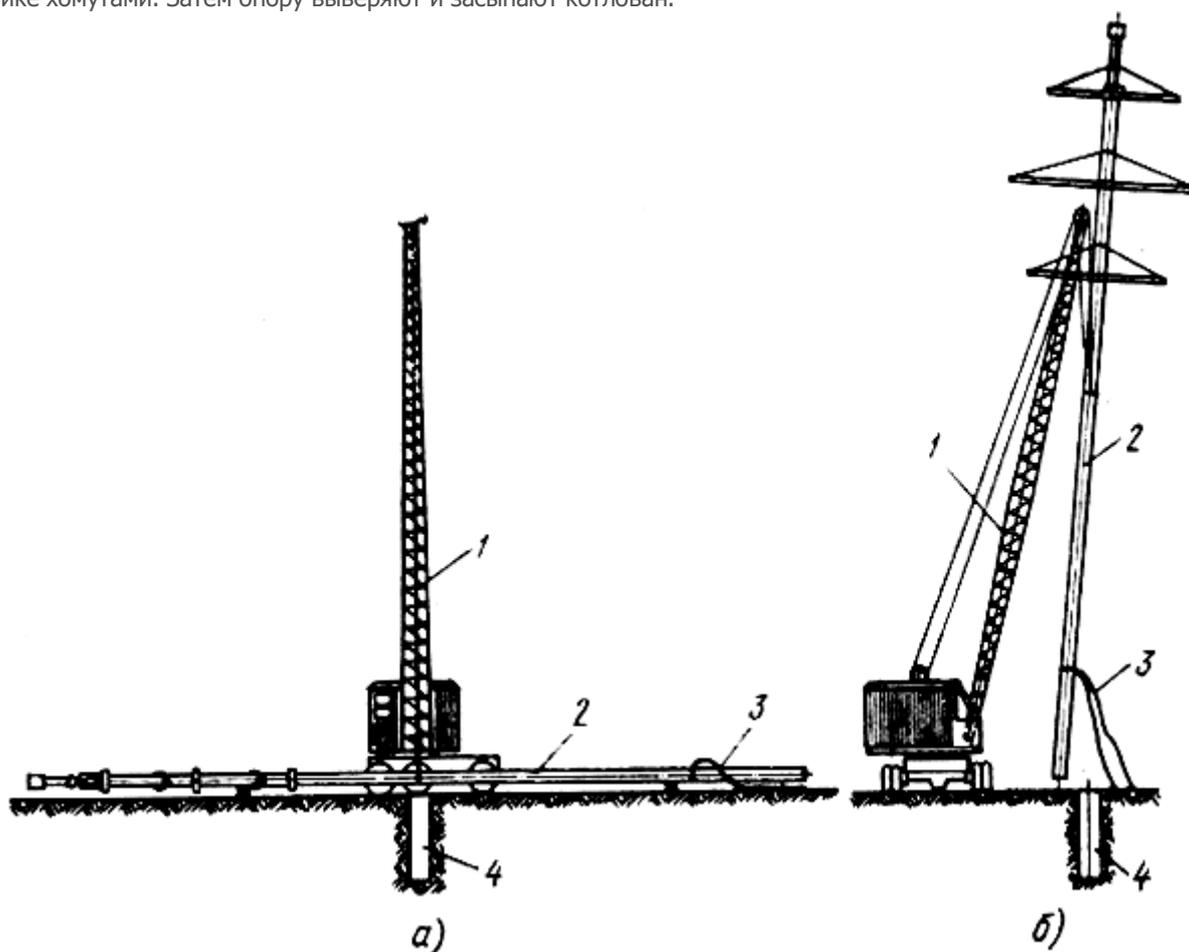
Установка одностоечной деревянной (железобетонной) опоры ВЛ 35-220 кВ краном:
